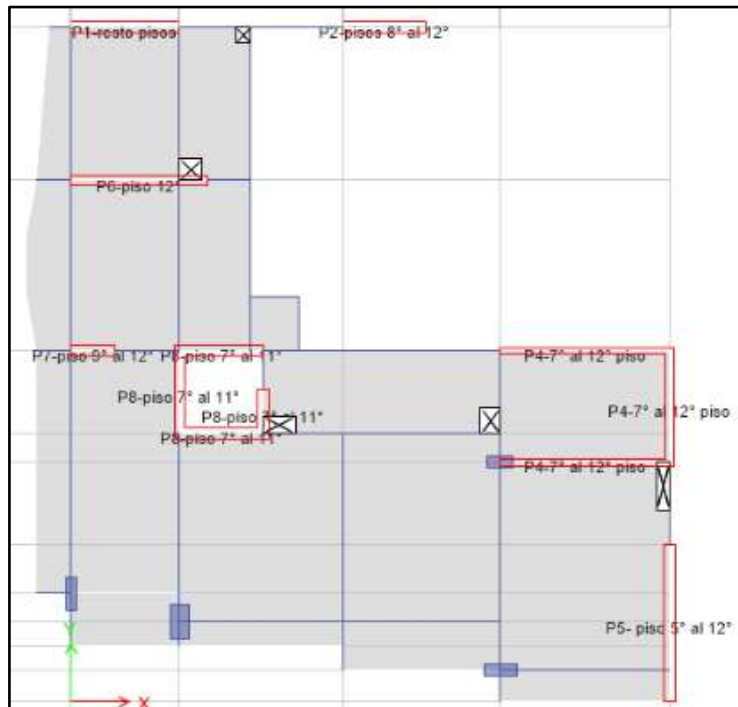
Vista en planta de M1 (piso 12°) en ETABS
